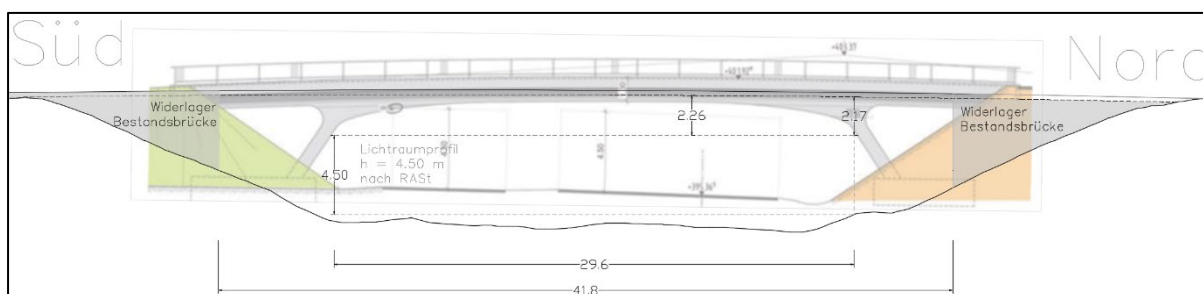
Längsschnitt der tragenden Konstruktion [Fuchs, M. et al: Neubau einer integralen Spannbetonbrücke, Beton- und Stahlbetonbau 112, Sonderdruck Februar 2017]
